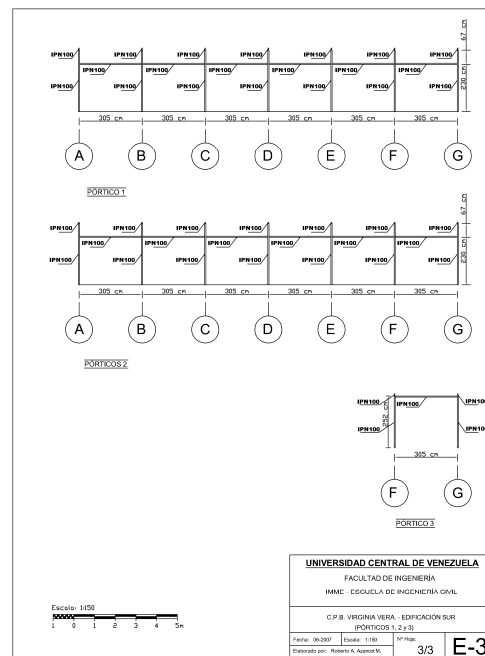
Plano E3: Plano Estructural de los pórticos 1, 2 y 3.
